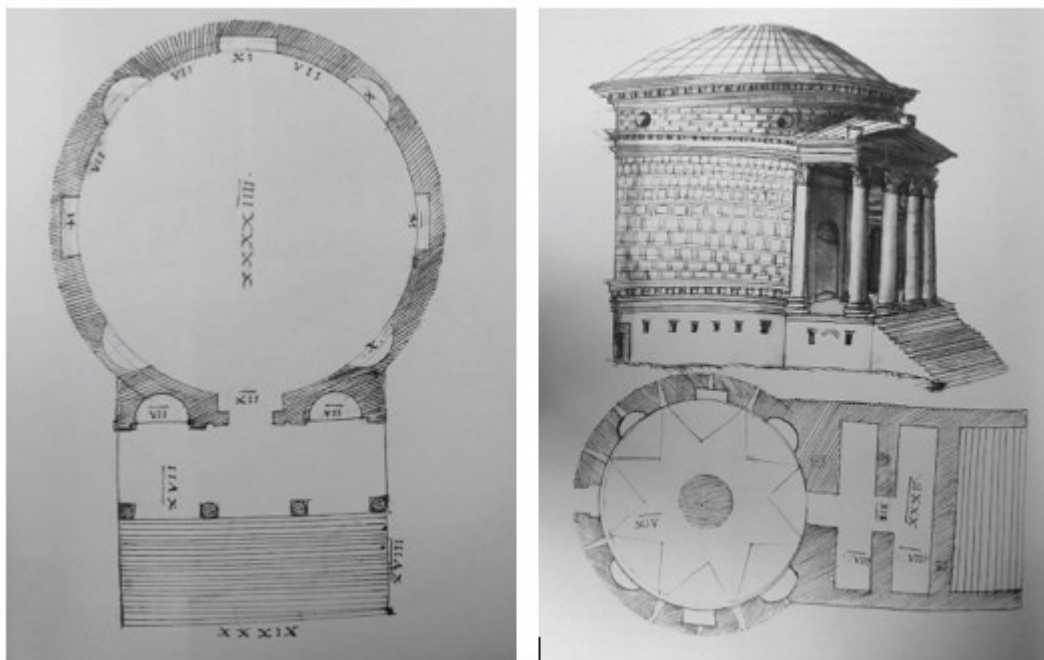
Pirro Ligorio, planimetria e alzato ricostruttivo del Mausoleo di Tor de' Schiavi – Oxon., foll. 33-33v [da CAMPBELL 2016, 49-50].
